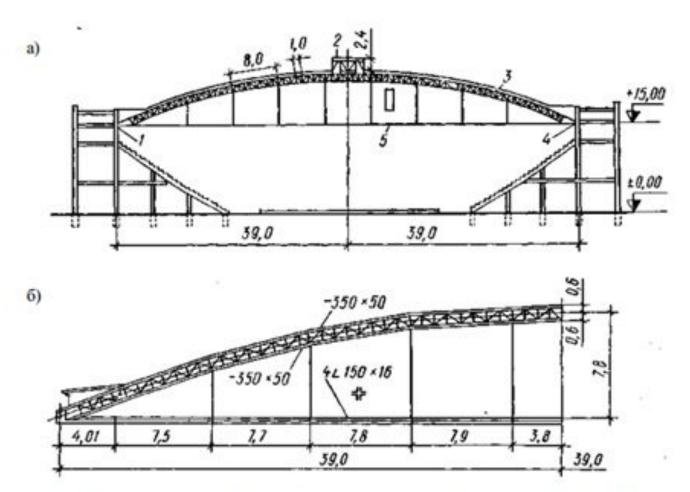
Конструкция арочного покрытия стальными арками с затяжкой Дворца спорта в Лужниках:
